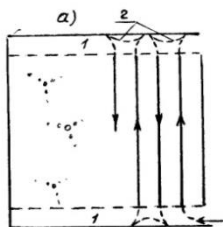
Схема работы корчевателя-собирателя челночным способом
